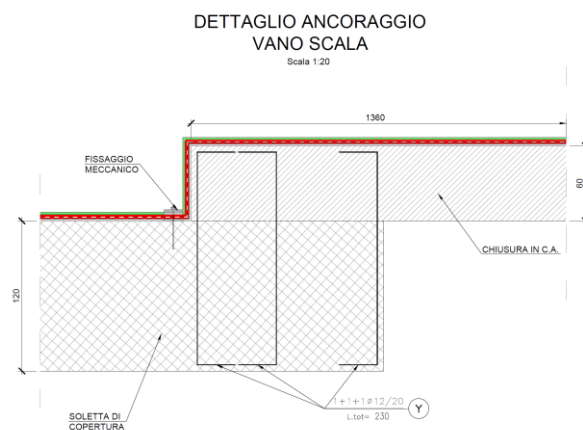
Collegamento tra soletta di chiusura e solettone di copertura della galleria
